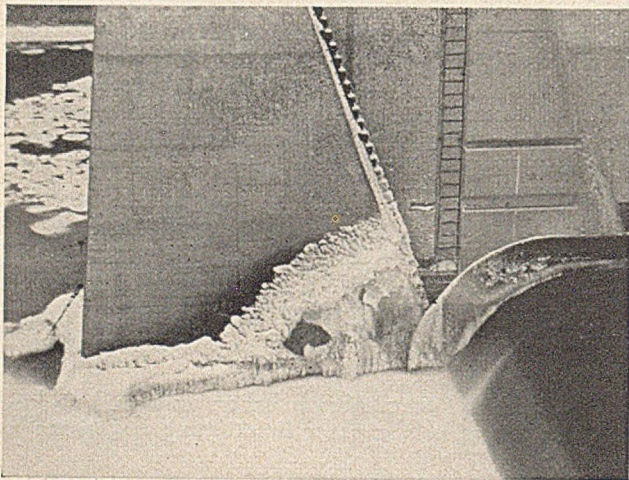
Versenkwalze: Vereisung der Pfeiler bei Überströmen der Walze im Winterbetrieb.
